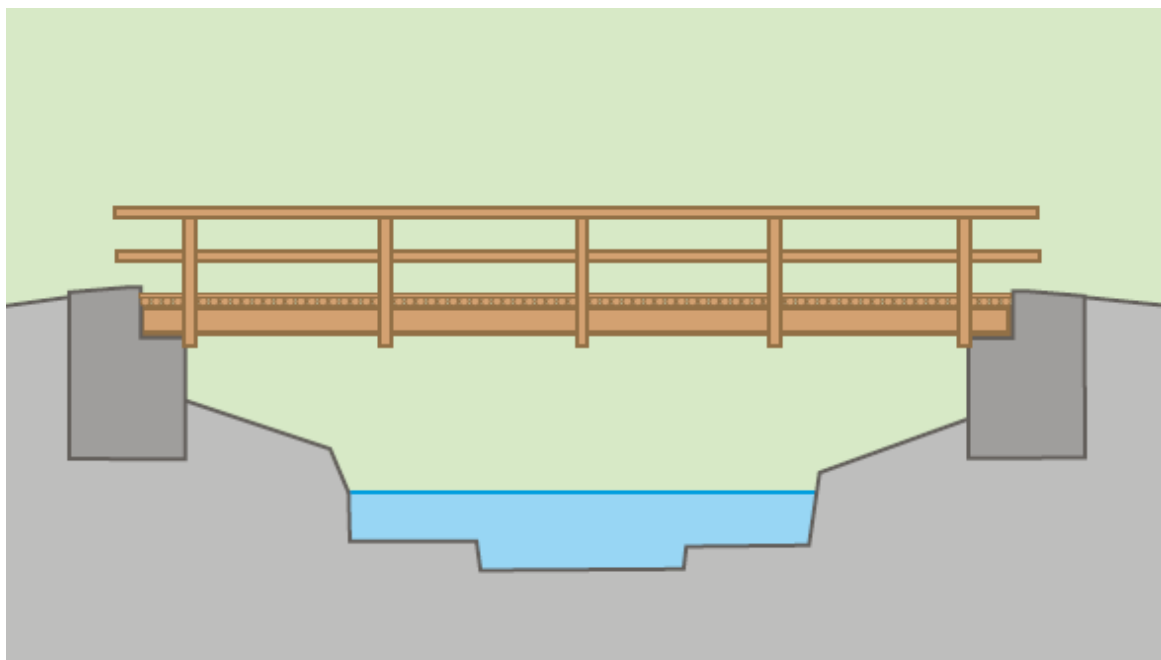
Holzbrücke im Längsschnitt (ASTRA)
